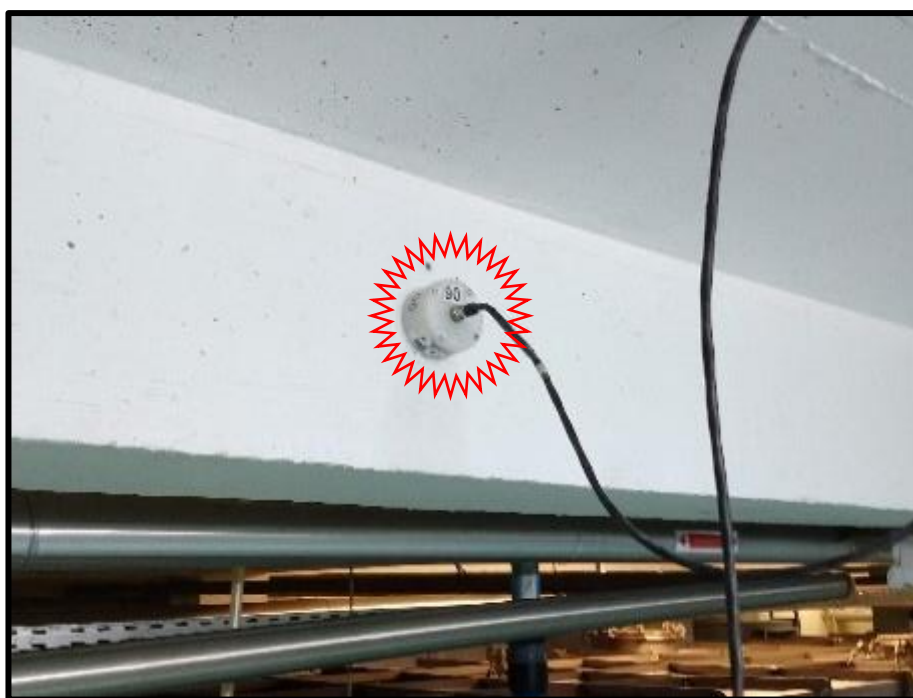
Transdutor fixo a estrutura metálica do mezanino.
